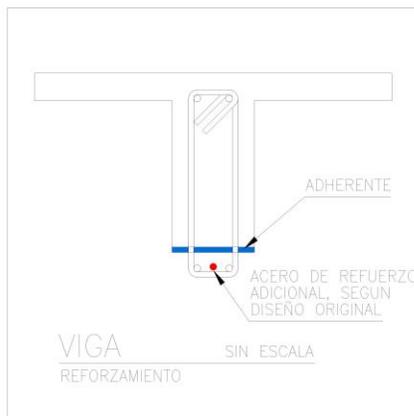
Incorporación del acero de refuerzo. Autocad 2005.
